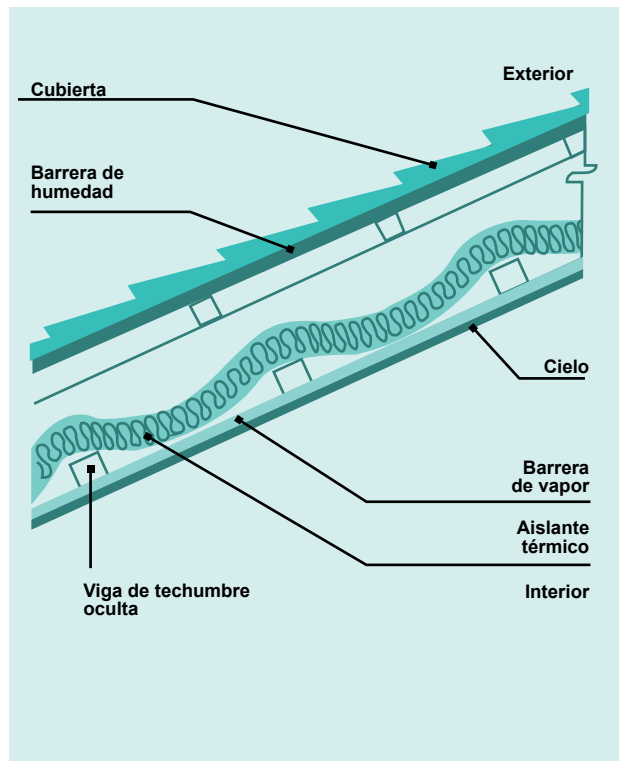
Aislante en techumbre caliente con vigas ocultas
